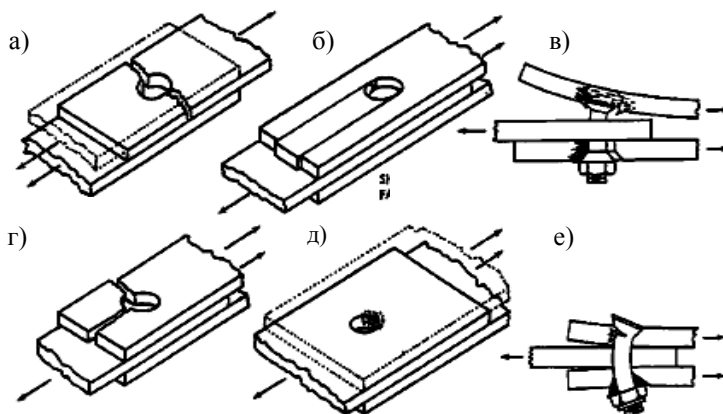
Схеми руйнування болтових з'єднань композитів GFRP [6]
